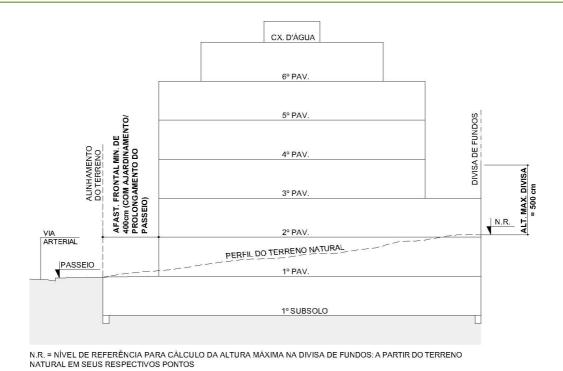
ADE Residencial Central - Edificação sem avanço sobre o afastamento frontal de via arterial
